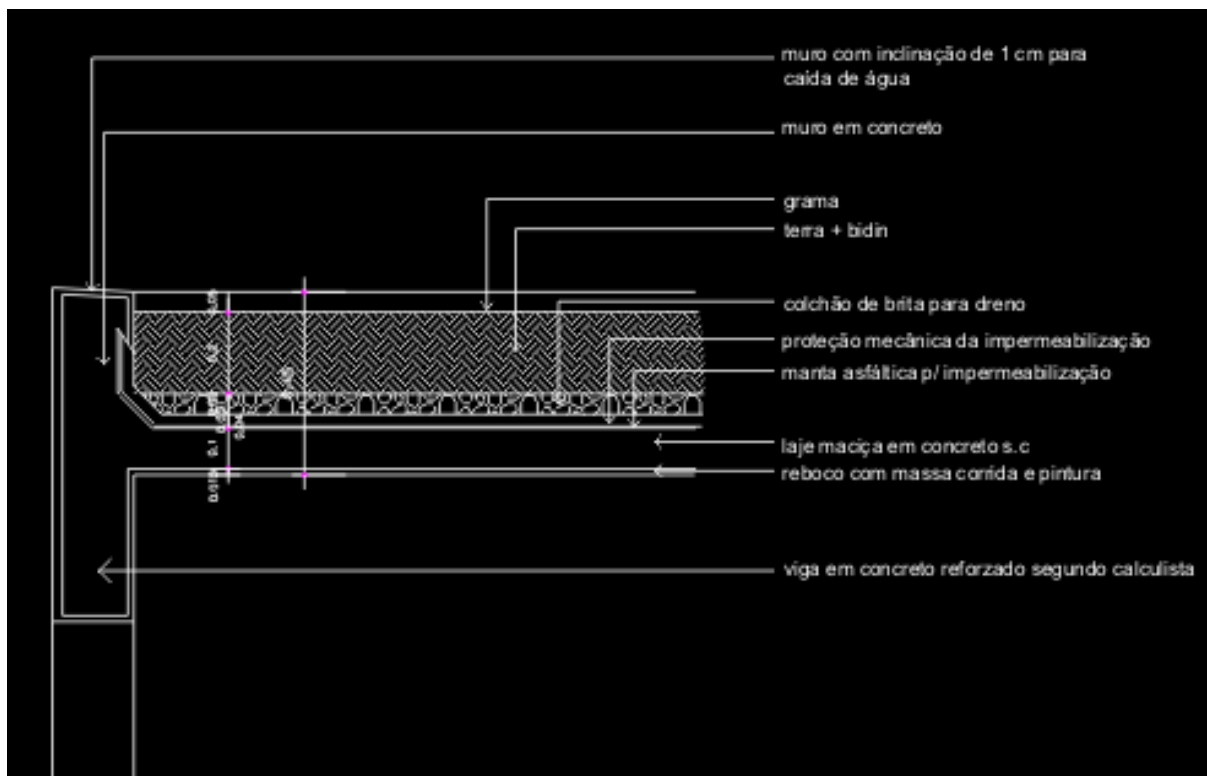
Detalhe laje com teto jardim. Projeto Condomínio Lagoinha. Florianópolis (Fonte da autora).
